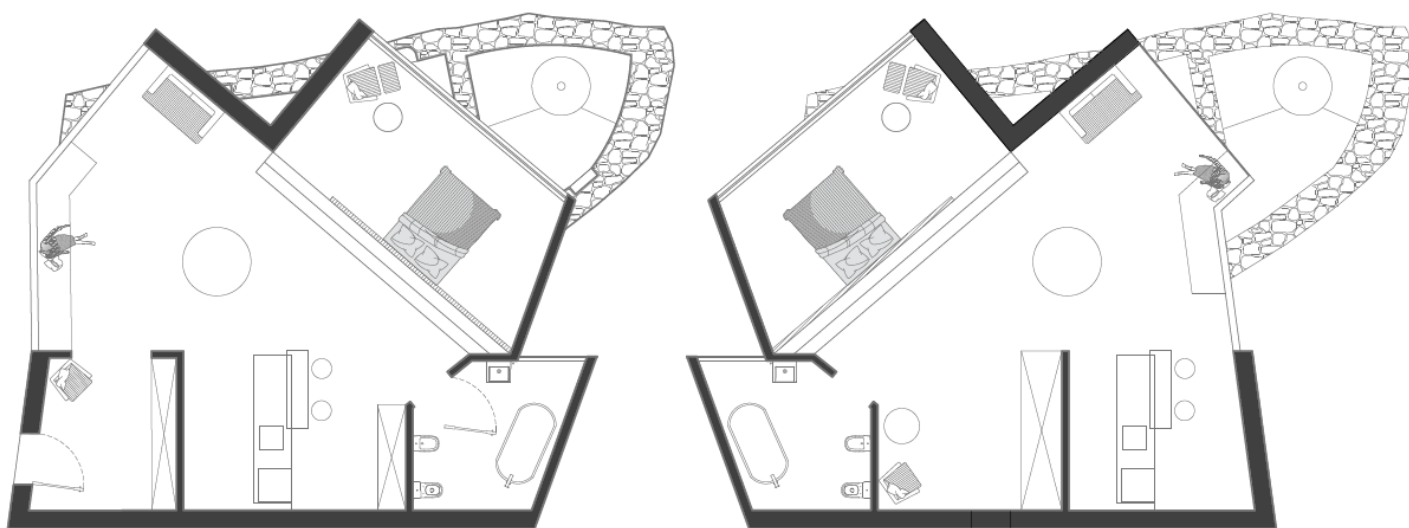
Casa 1: Planta do Proposto – Cave e R/Chão respetivamente. Esboço 4
